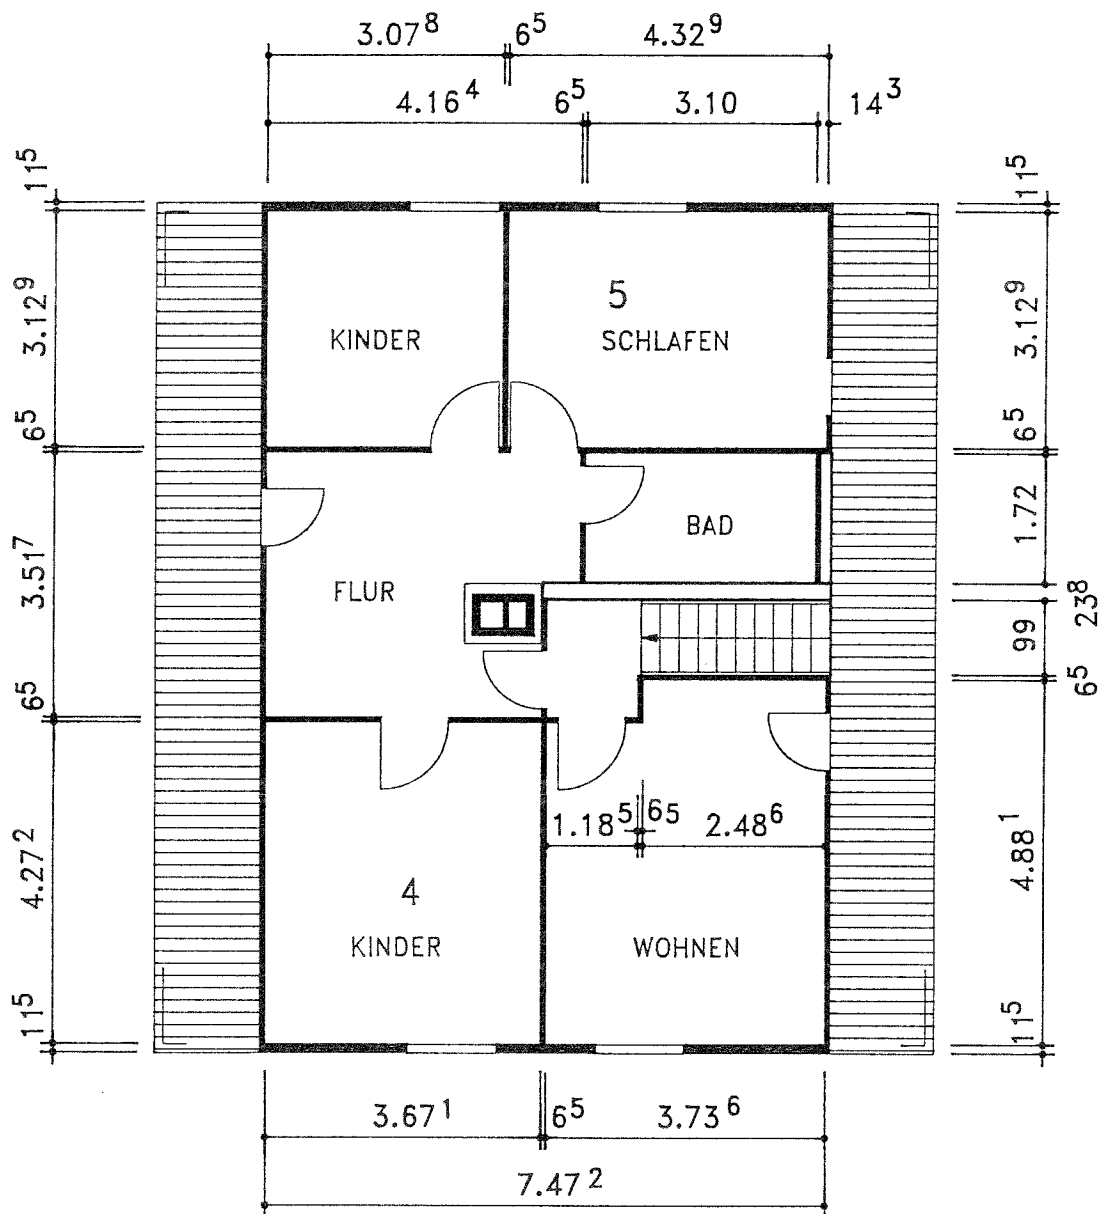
Dachgeschoßgrundriß des Fertighauses
